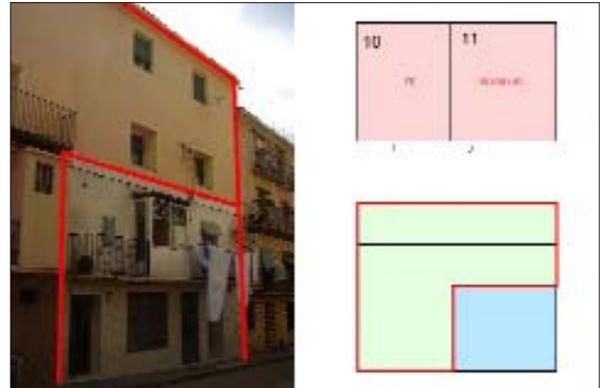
Información en el FXCC. Con croquis acotado por planta y foto
